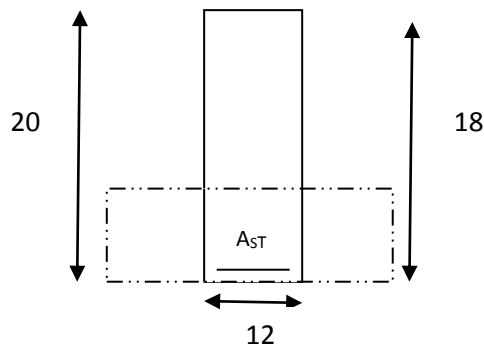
section de calcul de la poutrelle aux appuis
